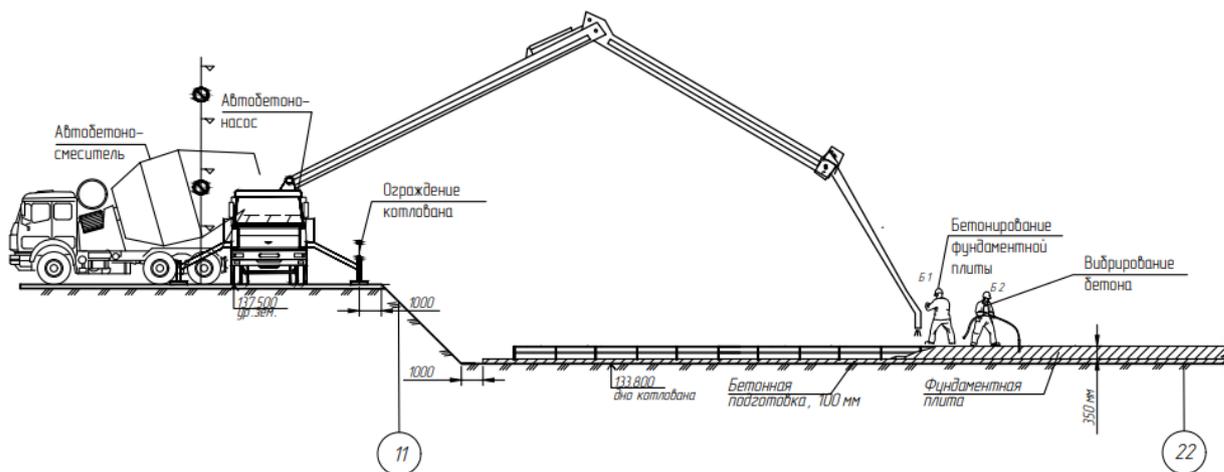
Подача бетона в конструкцию бетононасосом
